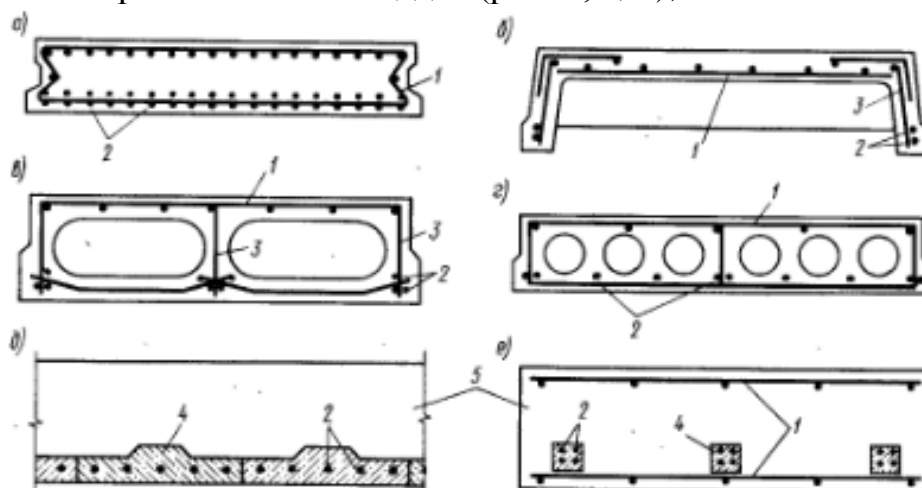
Поперечные сечения сборных и сборно-монолитных плит:
